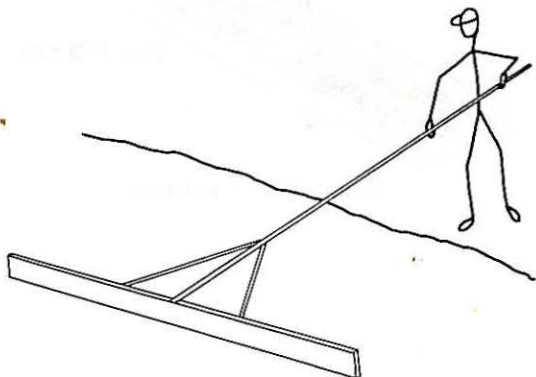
Kontroll av betongoverflatens planhet under grovbehandlingen kan utføres som vist her.
